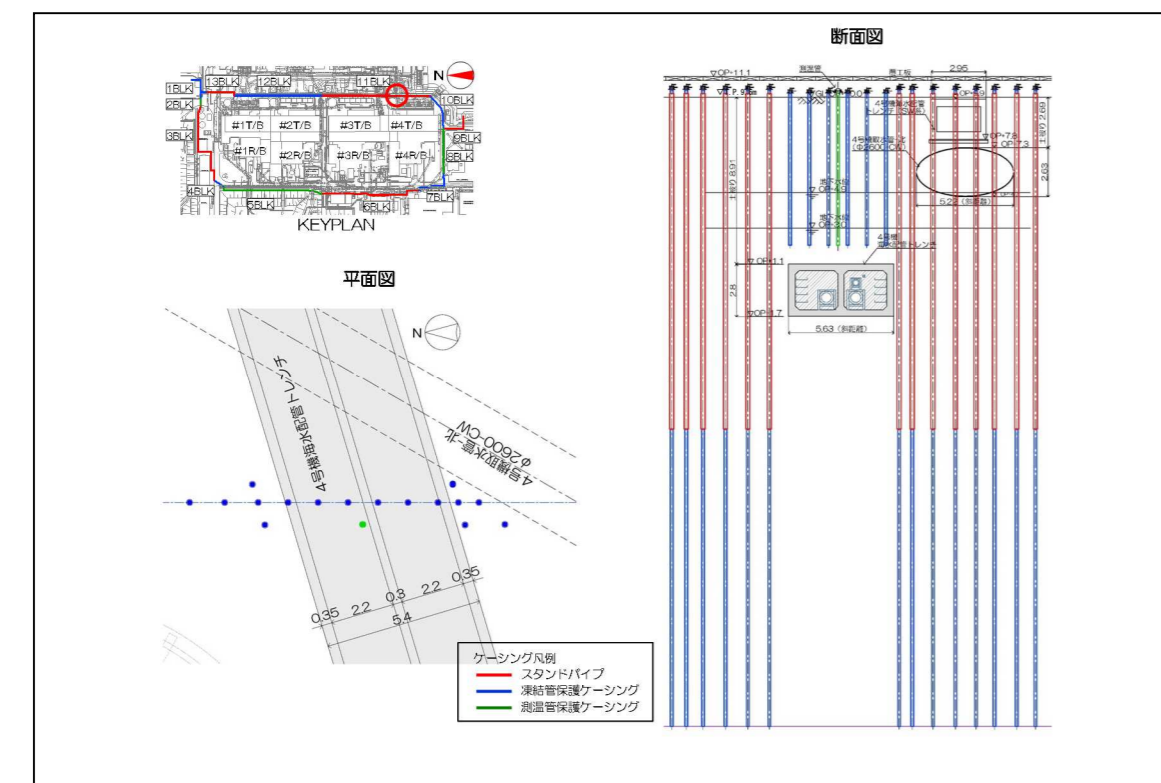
4号機海水配管トレンチ部 施工平面図・断面図
